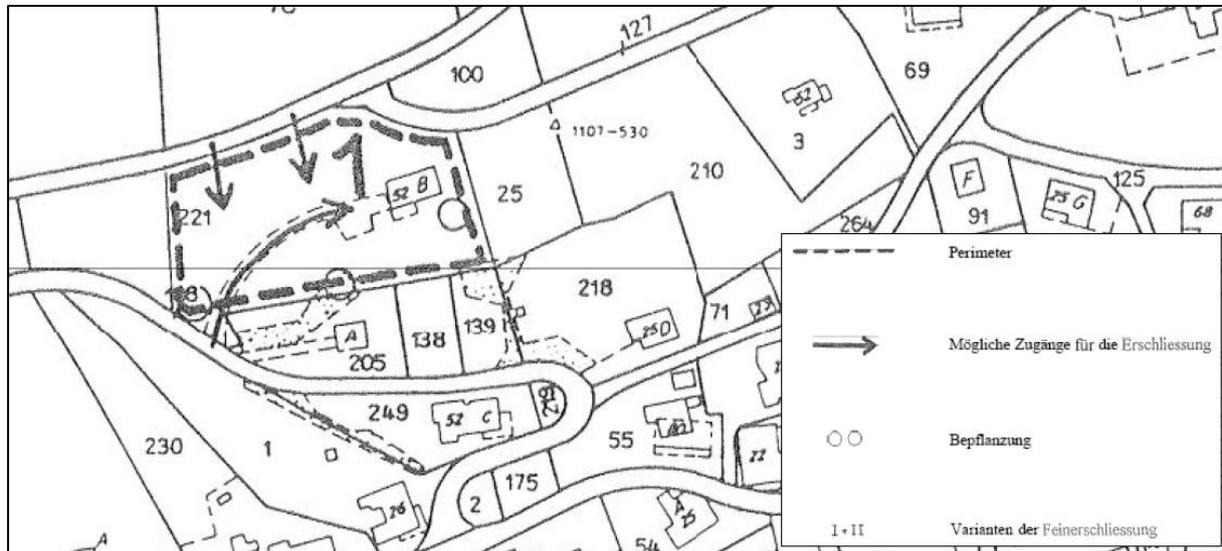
Skizze gemäss Anhang 1 Baureglement
